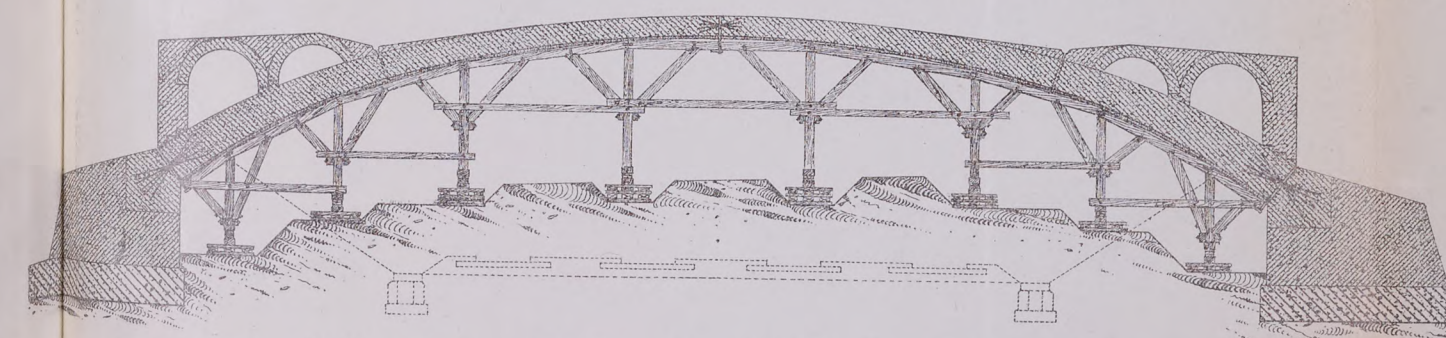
III Fase - Chiusura delle cerniere e costruzione dei muri frontali sopra le spalle
